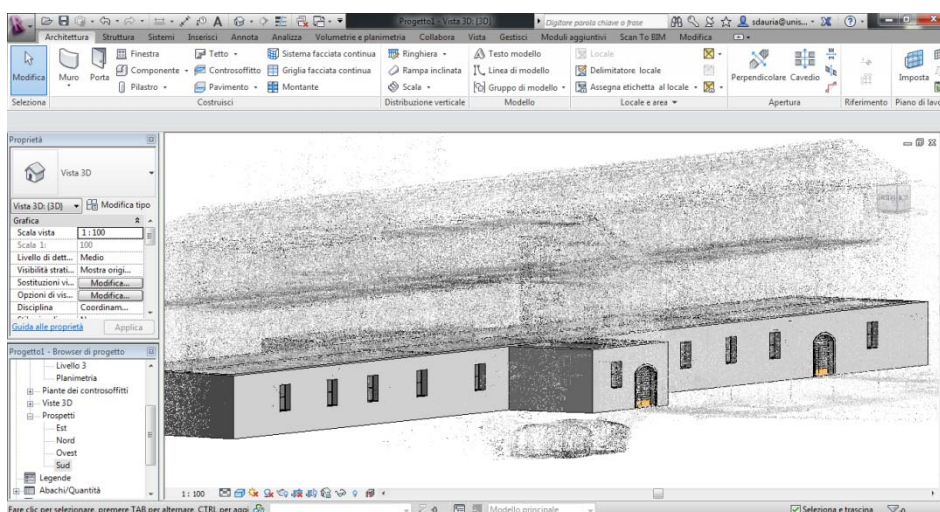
Modellazione bim del piano terra con muri, porte e finestre
